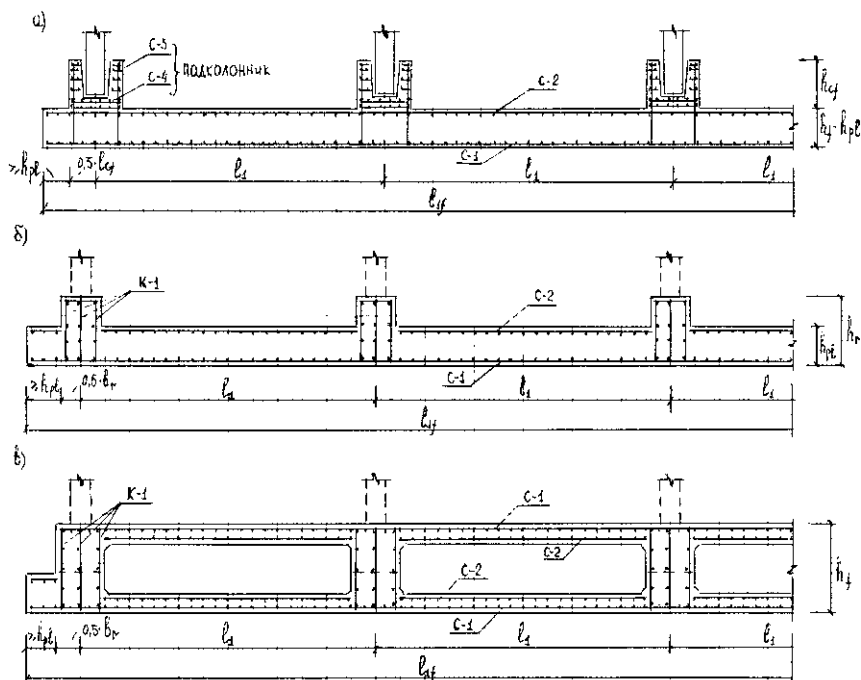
Армирование сплошных фундаментов: а – плоские, б – плитно-балочные, в – коробчатые
